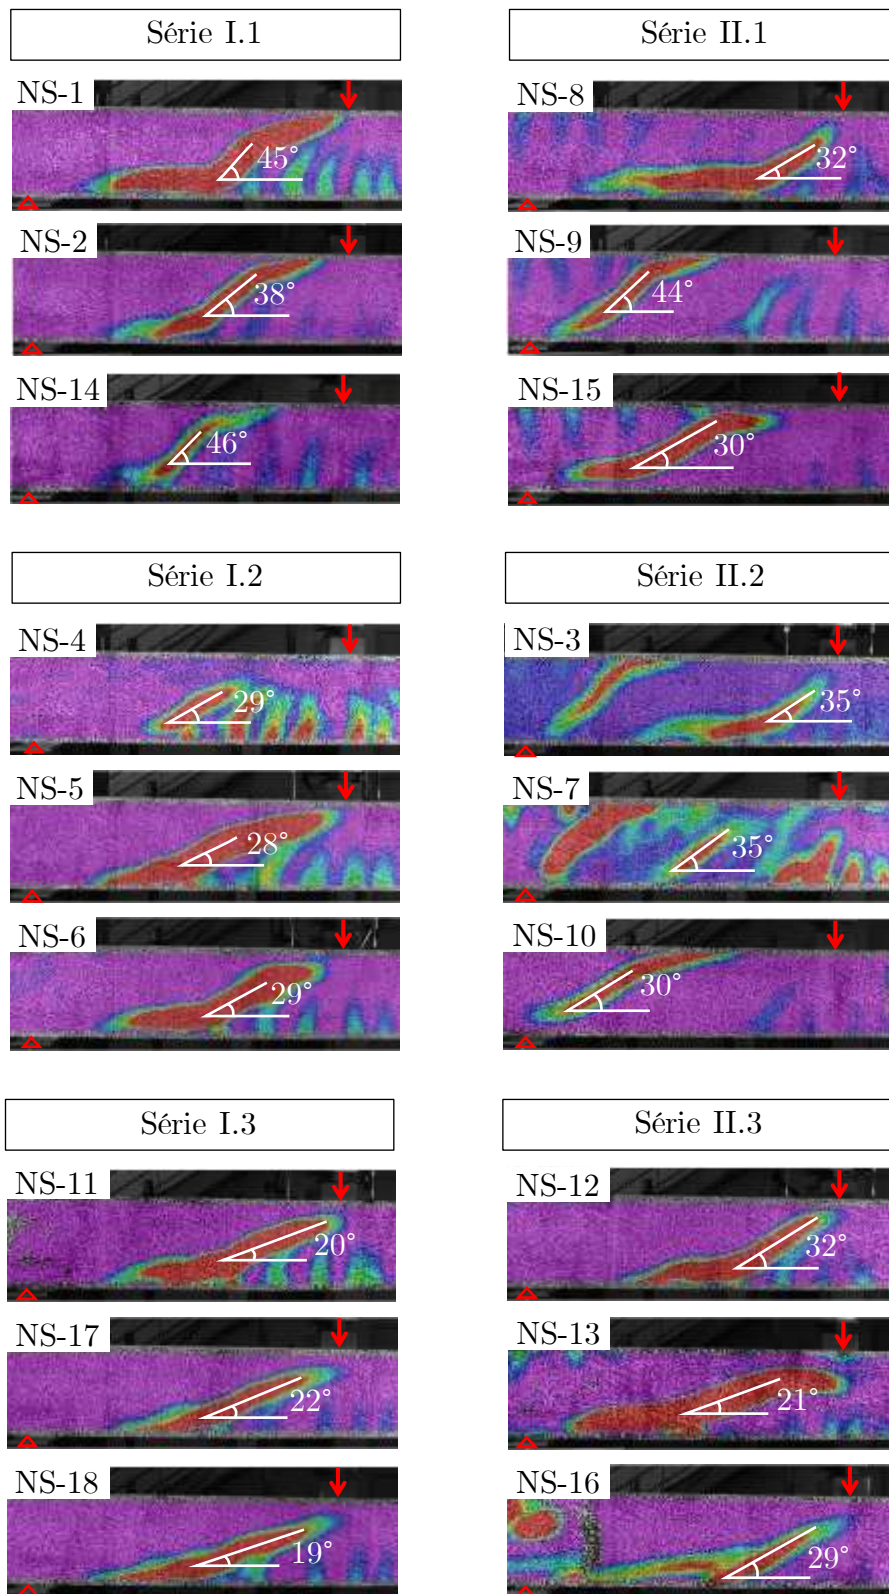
Fissures des poutres sans cadres
